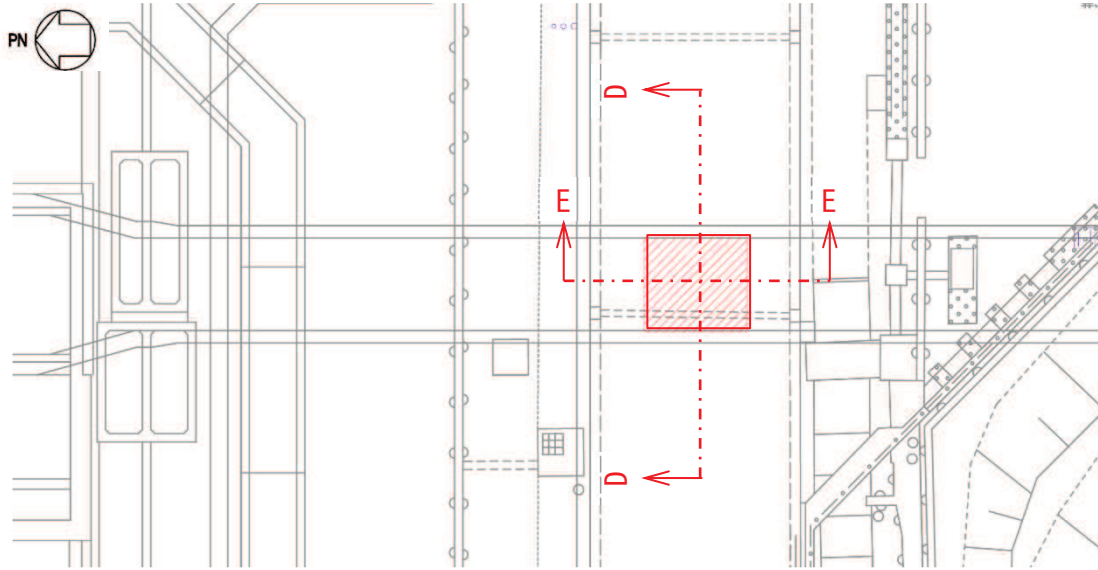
取放水路流路縮小工（第 1 号機放水路）の平面配置図
